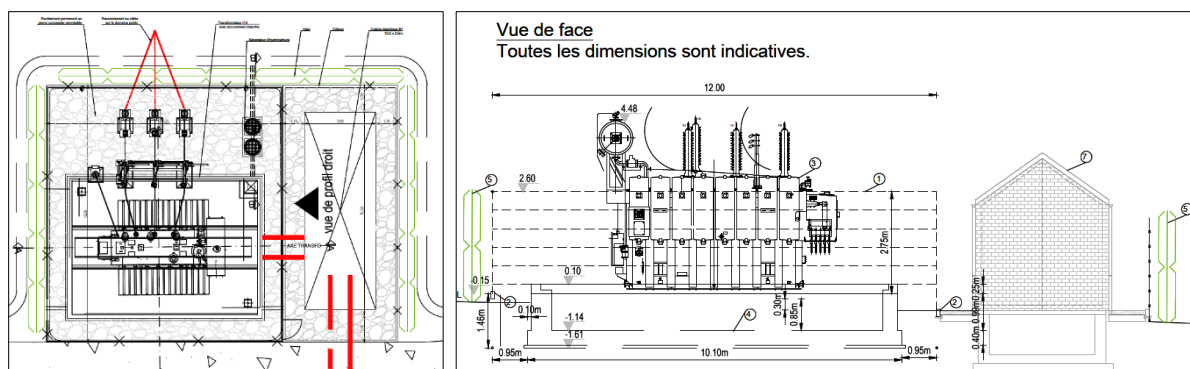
Vue en plan et vue en élévation de la sous-station électrique (source : Plans de la demande de permis, 2022) (Source : Sweco).
